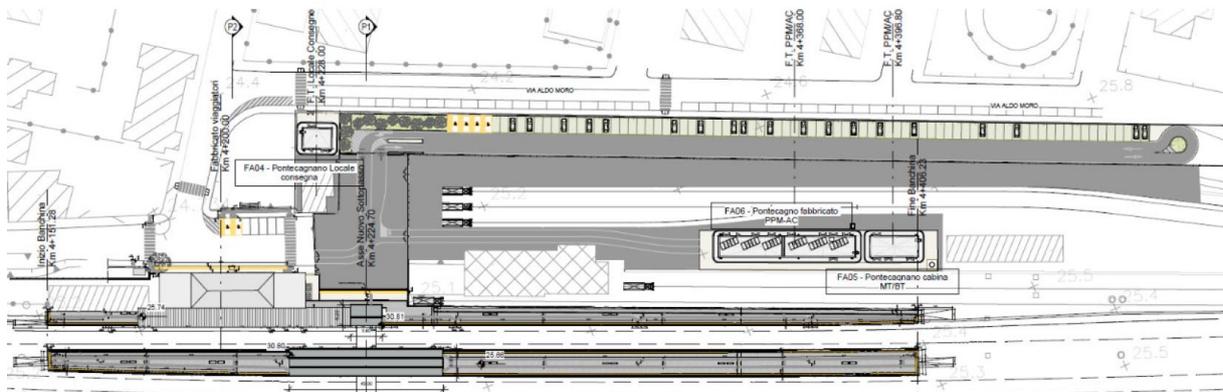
Planimetria generale della Stazione di Pontecagnano
